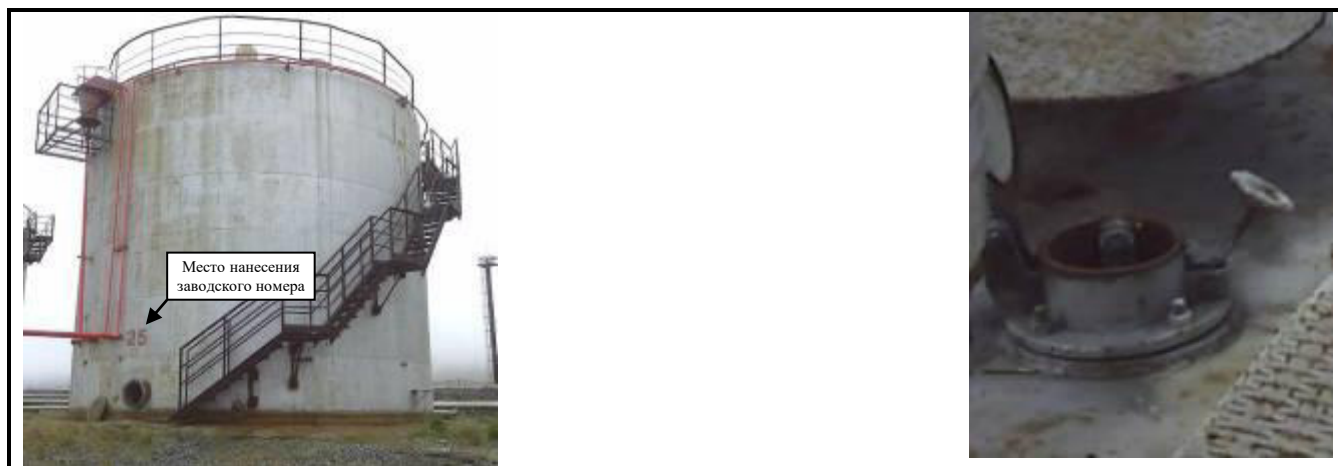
Общий вид резервуара РВС-700 (№25) с замерным люком
